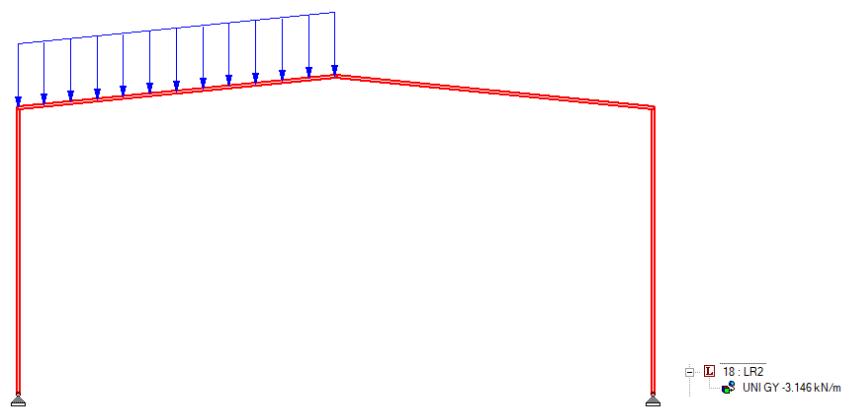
Sobrecarga de cubierta Lr2 del pórtico. Fuente: elaboración propia.
